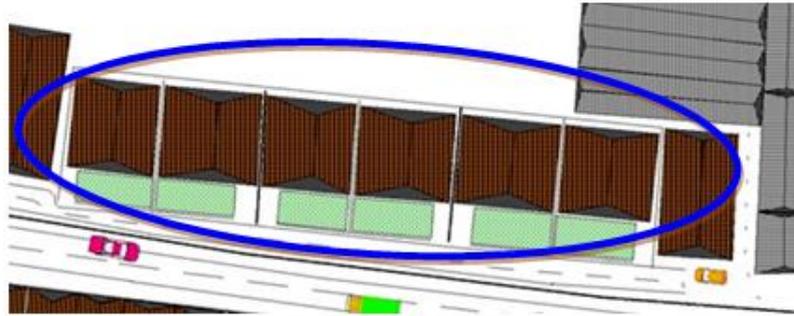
Tampak dan Denah Kantor PG Kreet
